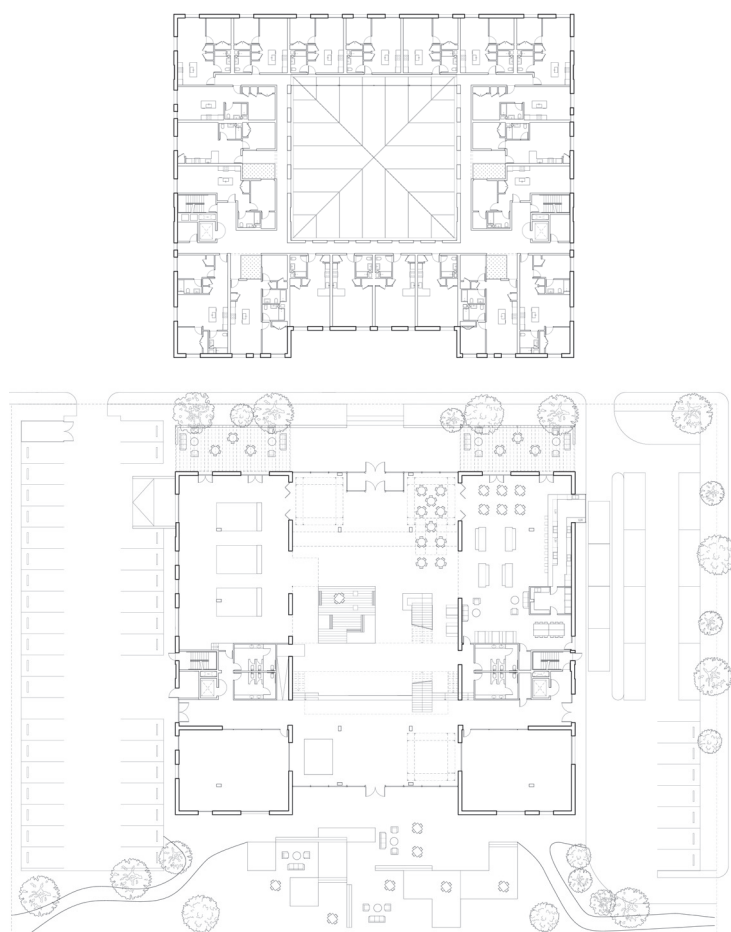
(Sopra) Pianta tipo dei piani residenziali con gli alloggi distribuiti su un impianto a ballatoio; (sotto) pianta piano terra. La corte interna assume il ruolo di luogo e spazio pubblico di incontro. Assonometria di progetto.
